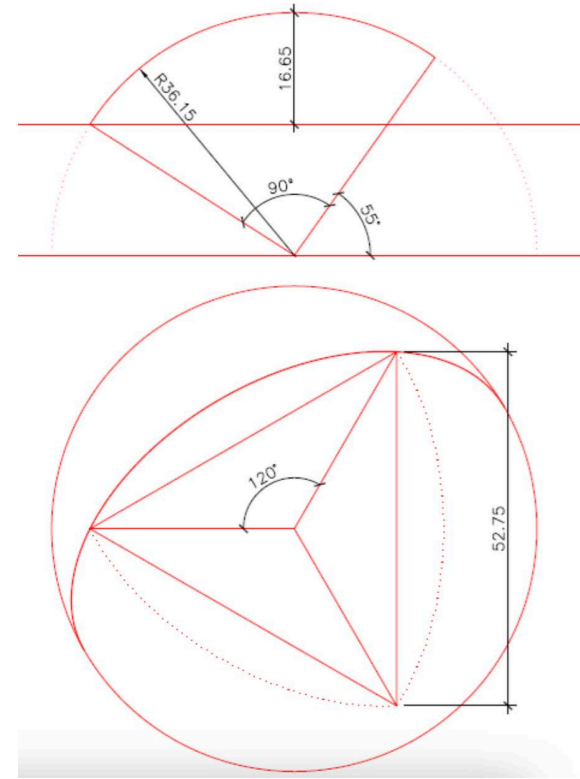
Planimetría del auditorio Kresge, secciones y planta respectivamente.
